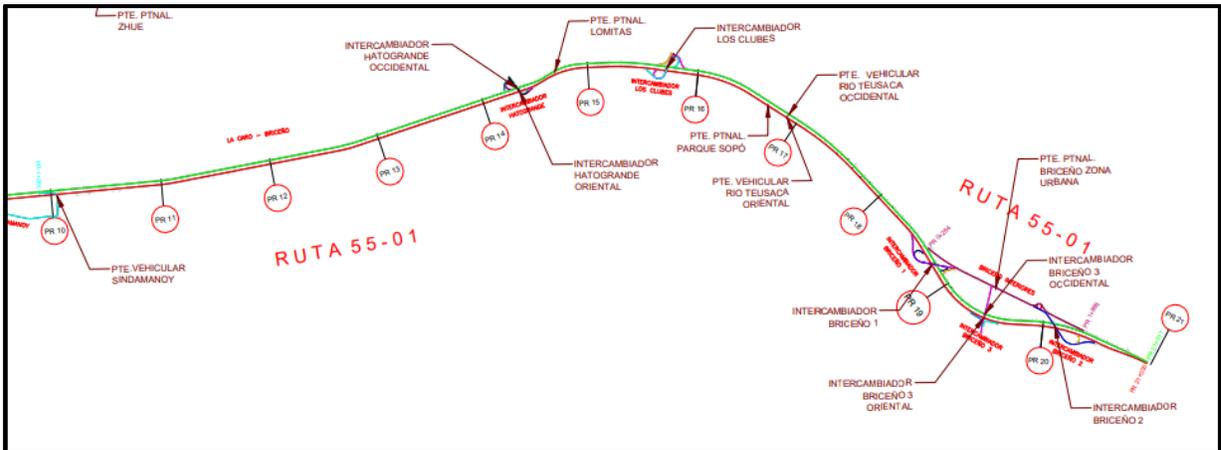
Ubicación de las estructuras de inspección Ruta 55.
